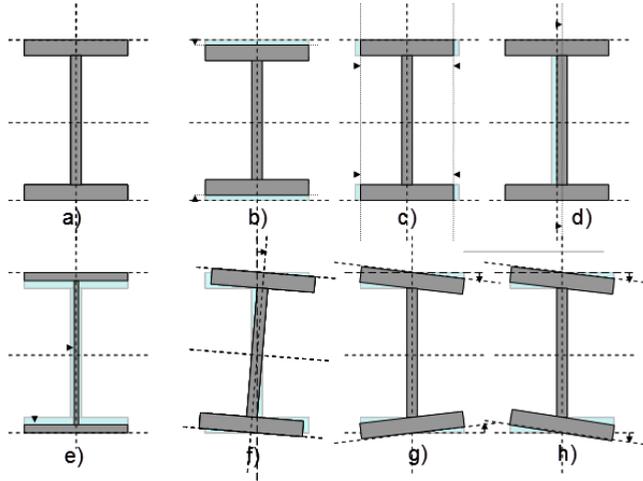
Imperfezioni locali, ovvero riferite alla sezione di un elemento strutturale: a) sezione perfetta; b) e c) imperfezioni sull'altezza e sulla larghezza della sezione; d) imperfezione sul posizionamento dell'anima rispetto alle ali; e) imperfezioni sugli spessori delle ali e dell'anima; f) torsione iniziale della sezione; g) e h) difetti di squadratura.
